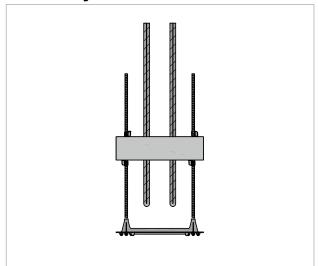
Schöck Sconnex® type W : vue du produit avec aide au montage
